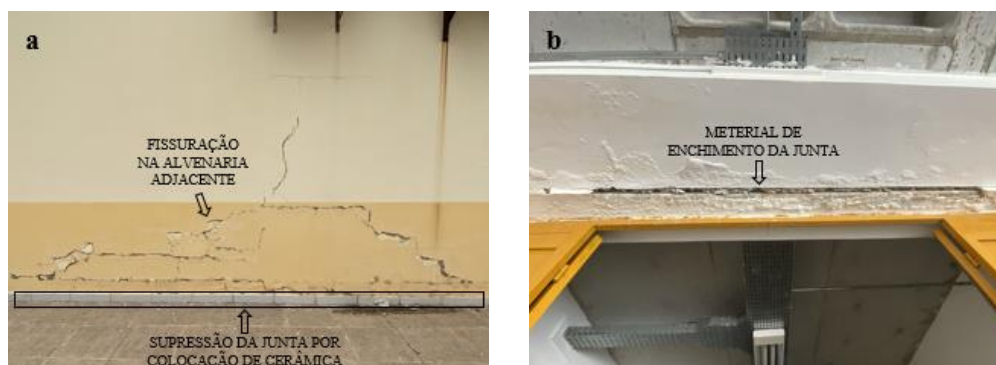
Junta de dilatação JD - a) fissuração da alvenaria adjacente e supressão da junta na parte superior da junta; b) degradação do material de enchimento na parte inferior da junta.
